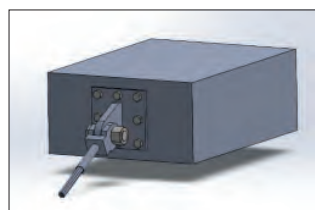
Моделирование узла крепления вант к железобетонному пилону
